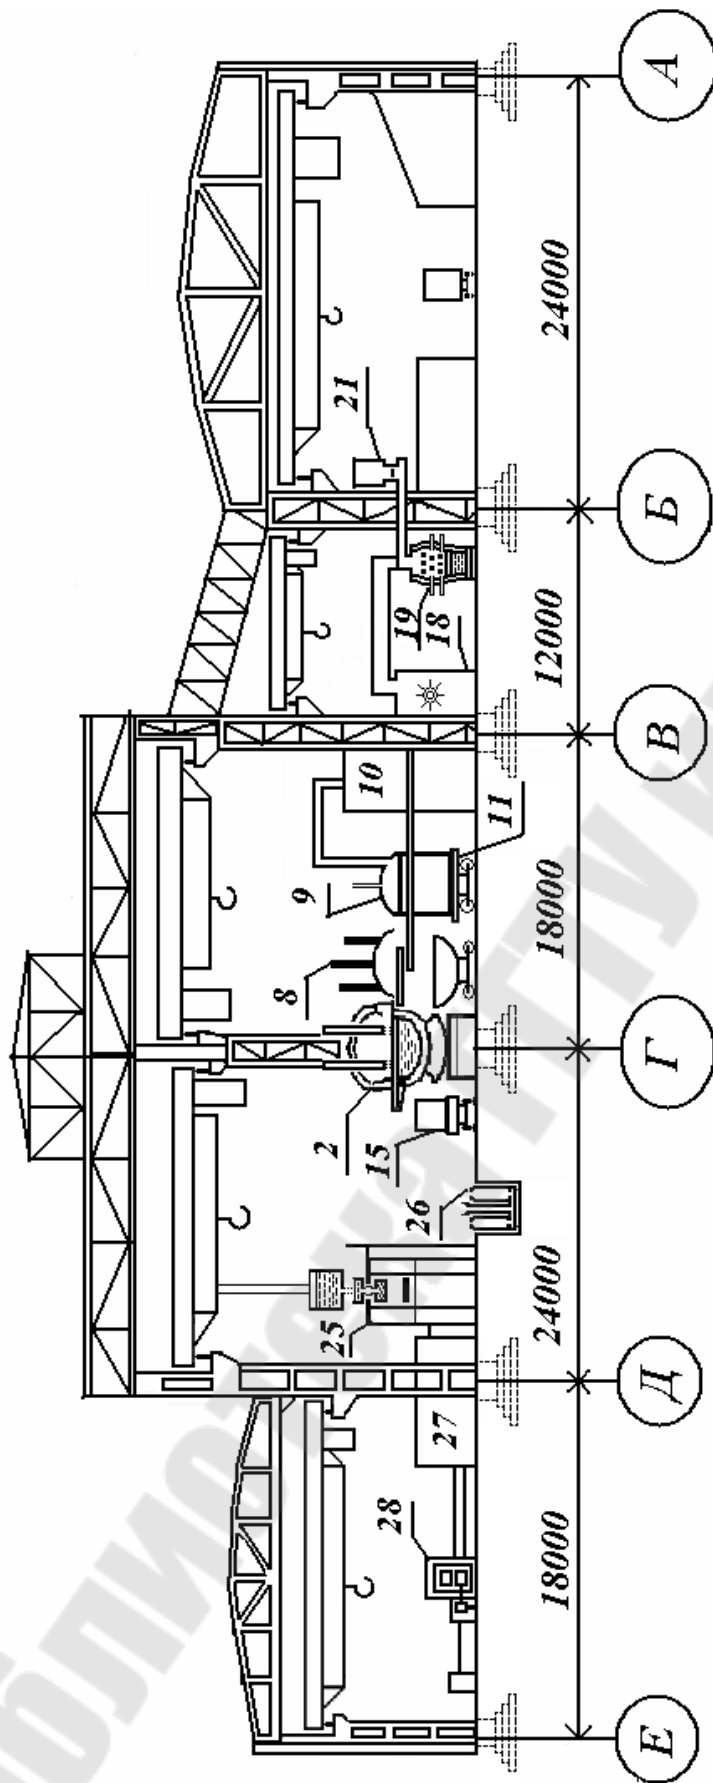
Поперечный разрез сталеплавильного цеха с РОМЕЛТ. (Обозначения те же, что на рис.10.)
